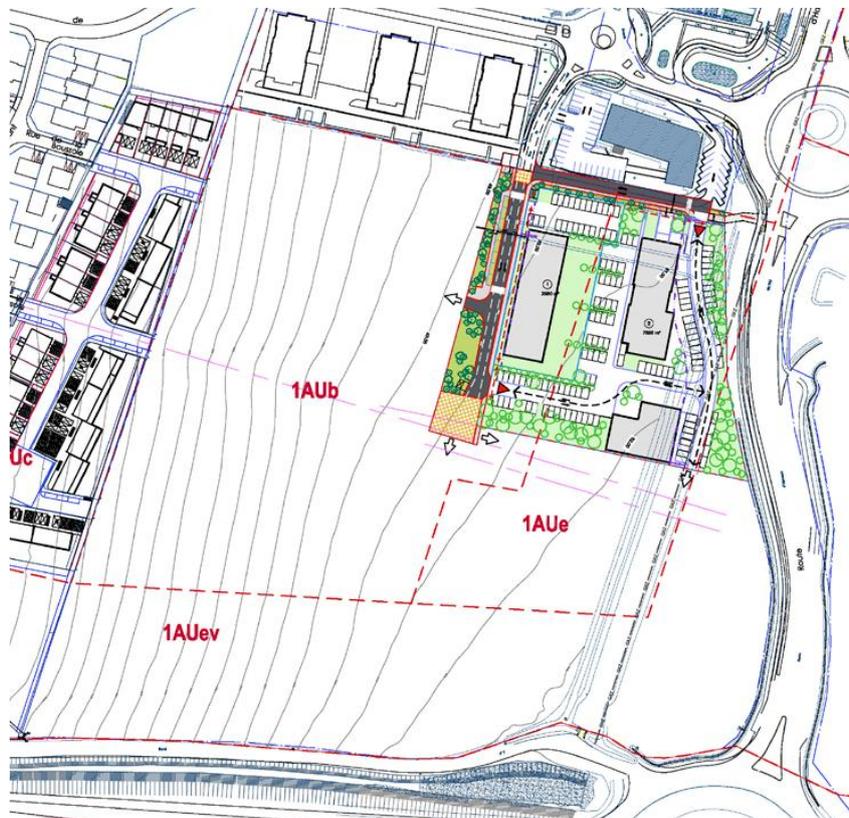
Plan d'aménagement global du projet - Source : Vert Latitude
